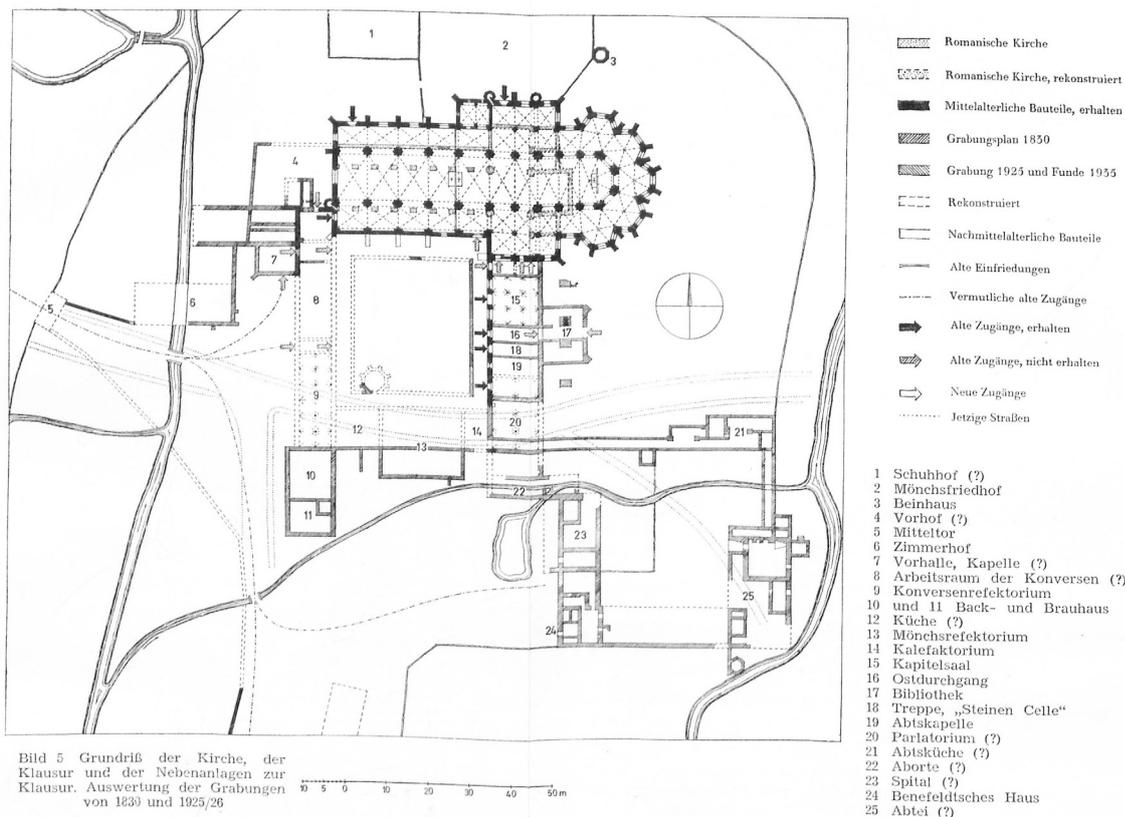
Grundriß der Kirche, der Klausur und der Nebenanlagen zur Klausur. Auswertung der Grabungen von 1830 und 1925/26
